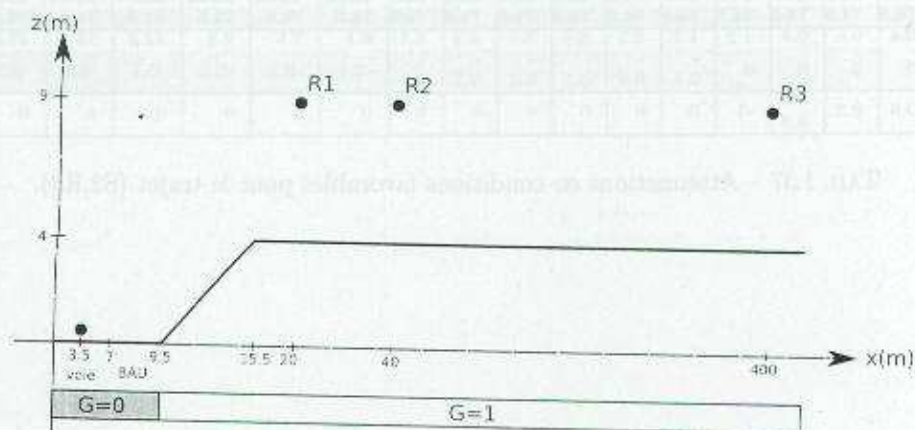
Coupe verticale du site en déblai de 4 m.
